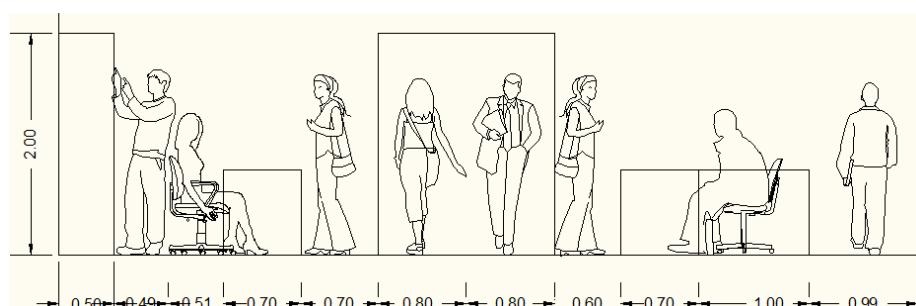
Denah Ruang Sirkulasi dengan dipotong di bagian tempat absensi dan ruang staf
